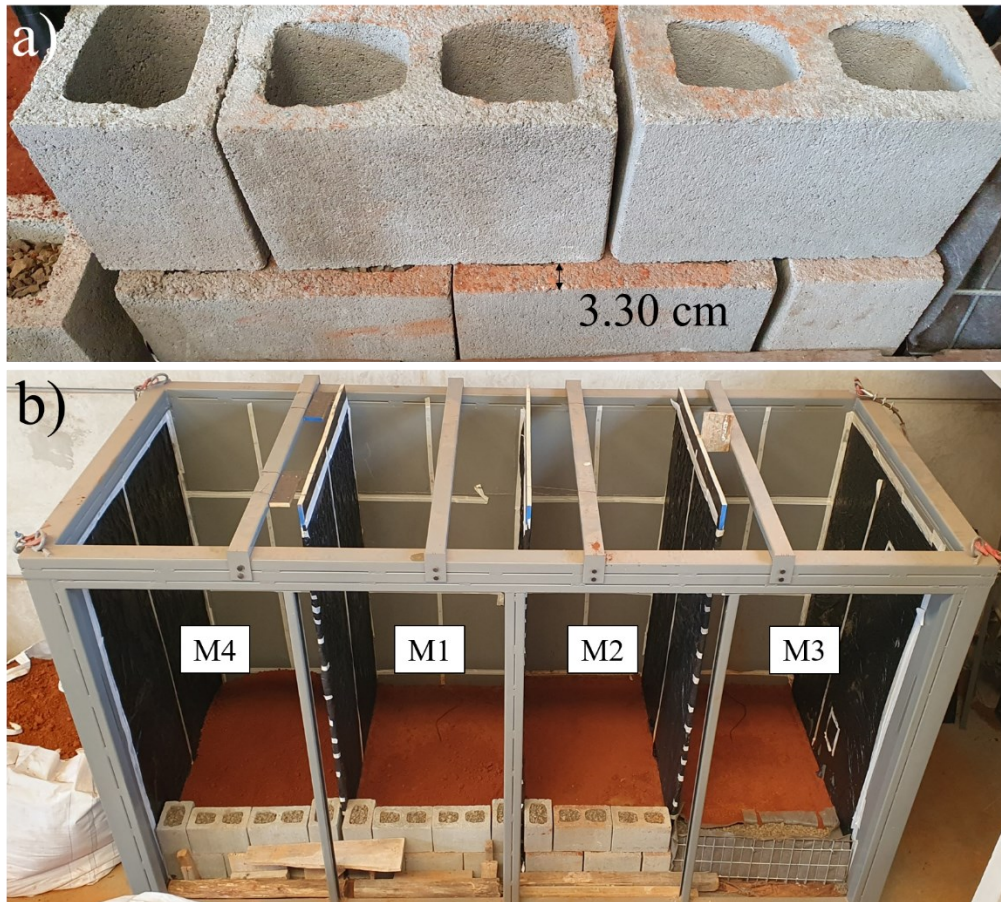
a) Posicionamento blocos de concreto fiada superior; b) Segunda fiada blocos de concreto da face modelos e primeira tela metálica.
